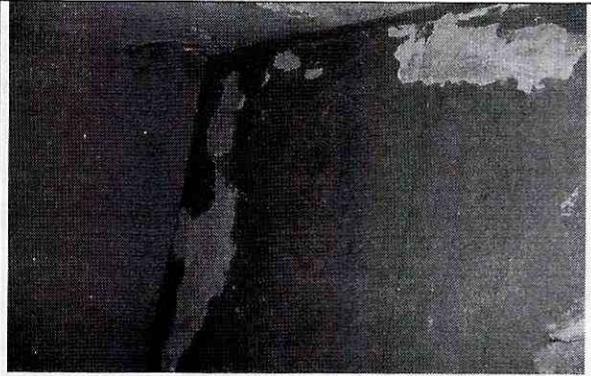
Deterioro en acabados de muros del segundo piso de la zona posterior
